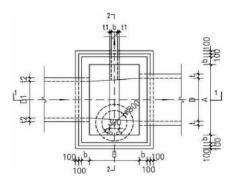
初期雨水弃流井井室平面图 (单位: mm)
